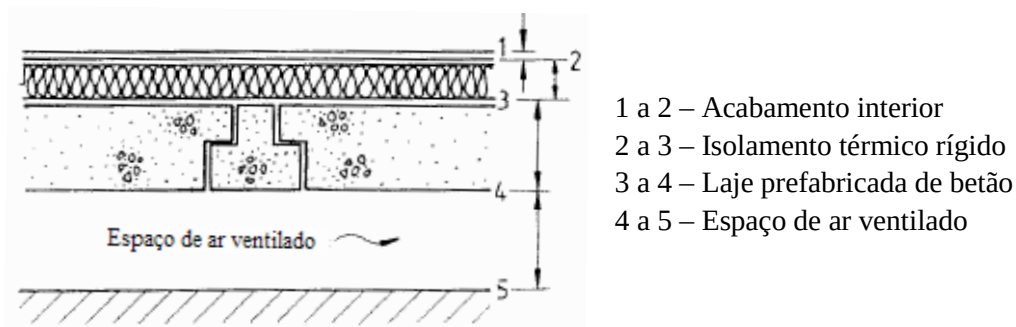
Constituição de pavimentos sobre desvão sanitário com estrutura de suporte em laje prefabricada de betão [2]
